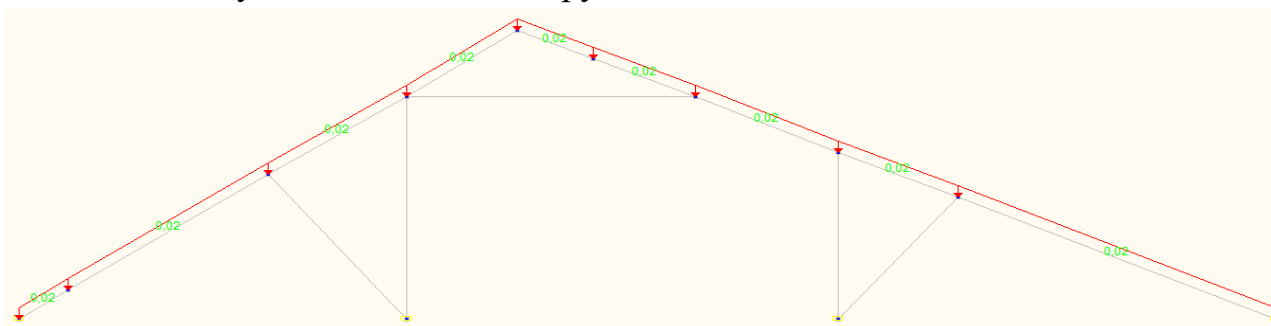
Схема загрузки постоянной нагрузкой от кровли
